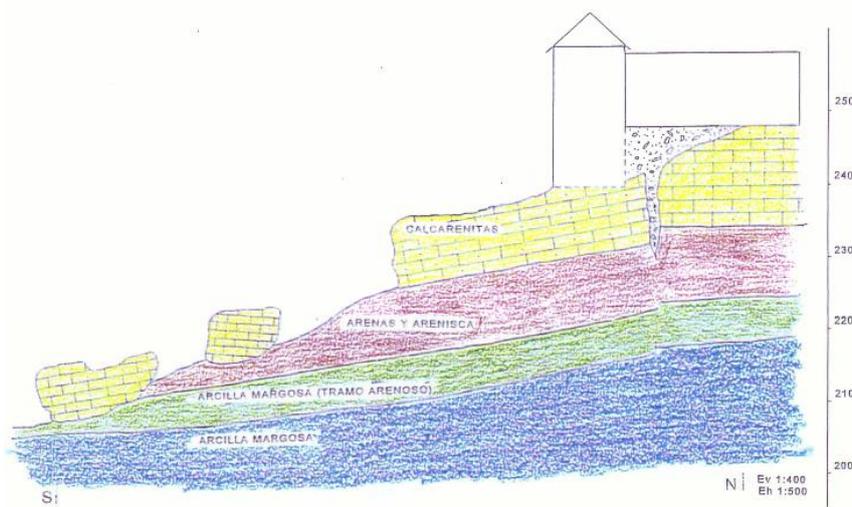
Situación de la grieta producida por el terremoto. Ilustraciones cedidas por el CEDEX.
